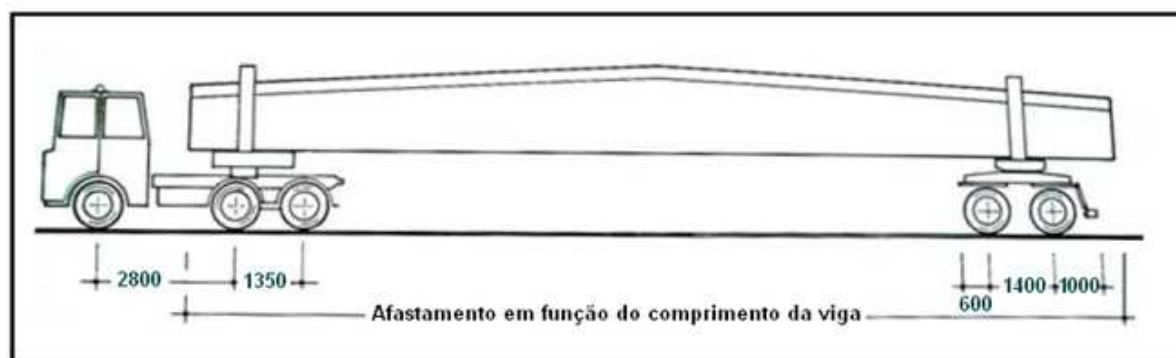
Vigas principais de cobertura ou vigas delta (Painsa, 2013)
